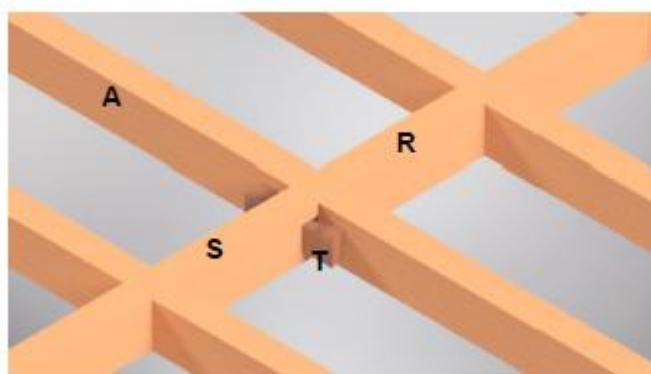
Representação esquemática das vigas do pavimento. A - Viga do pavimento; T - Tarugo; S - Tarugo de chaveta; T - Palmeta [9].
